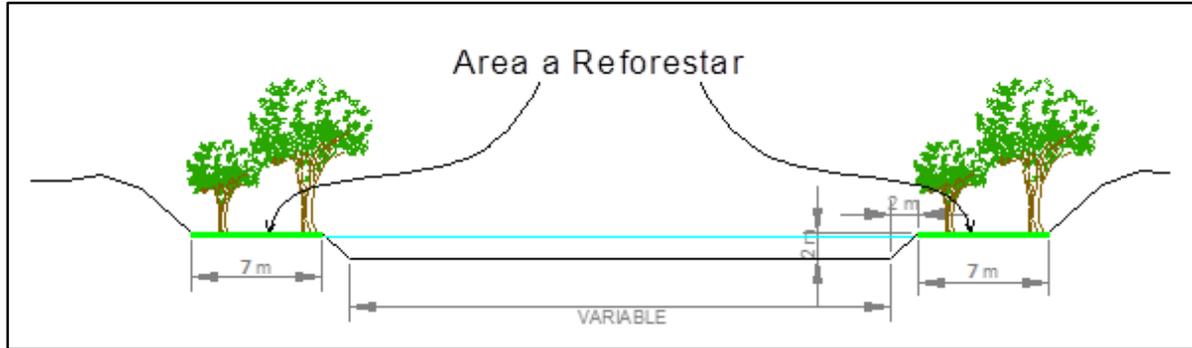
Sección tipo del cauce con el proyecto finalizado.
